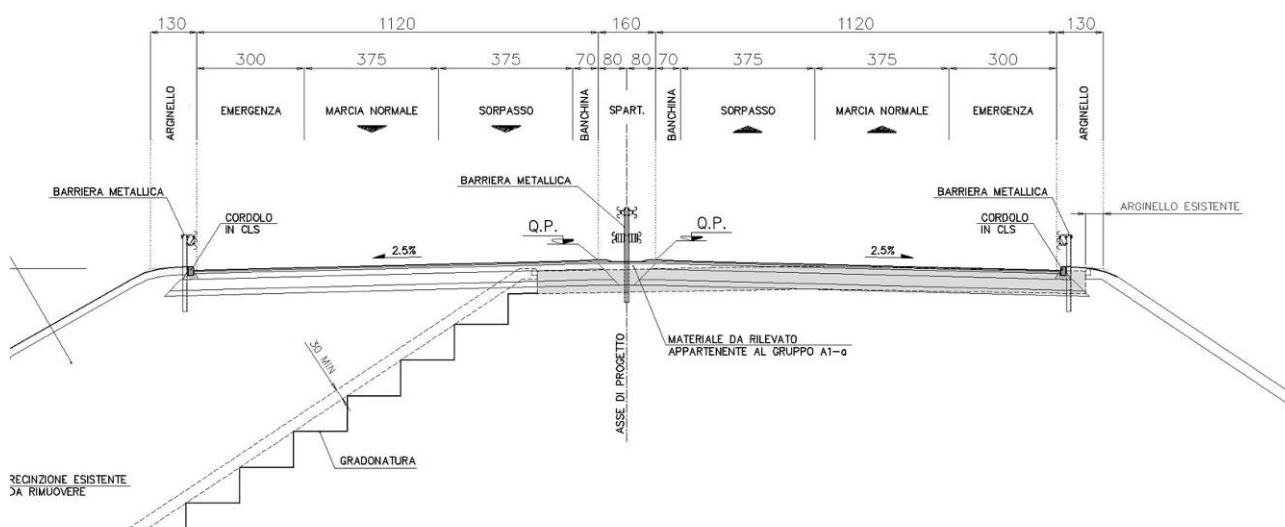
Sezione tipo di progetto (adeguamento asimmetrico SS1 Aurelia)
